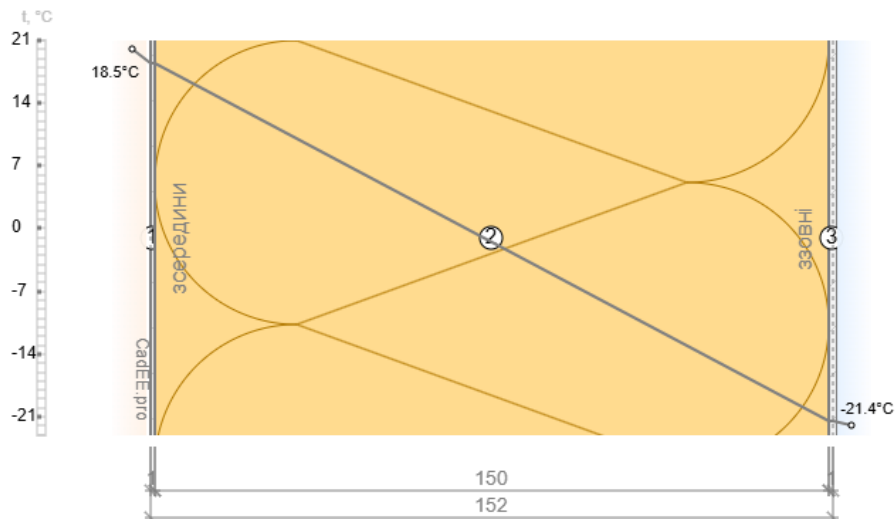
Розрахункова огорожувальна конструкція
